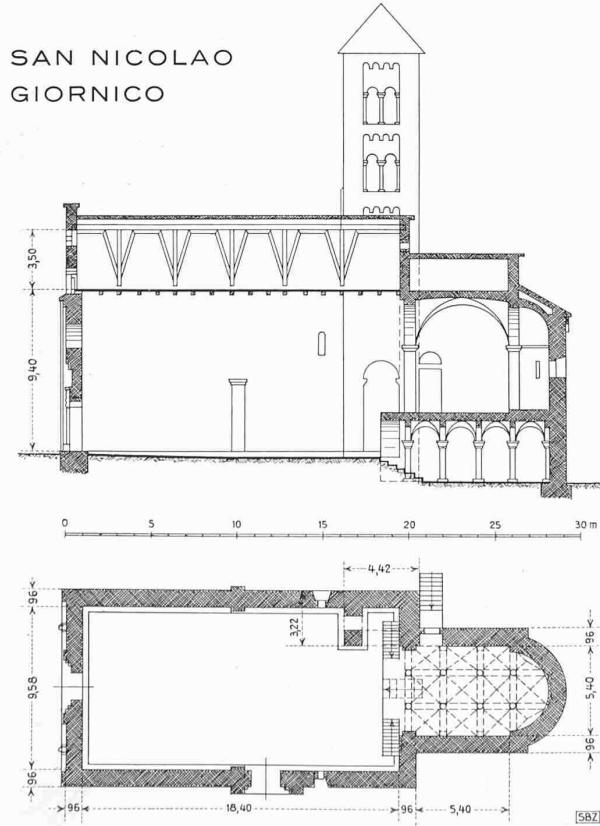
u. 5. Grundriss und Längsschnitt. — Masstab 1:400
